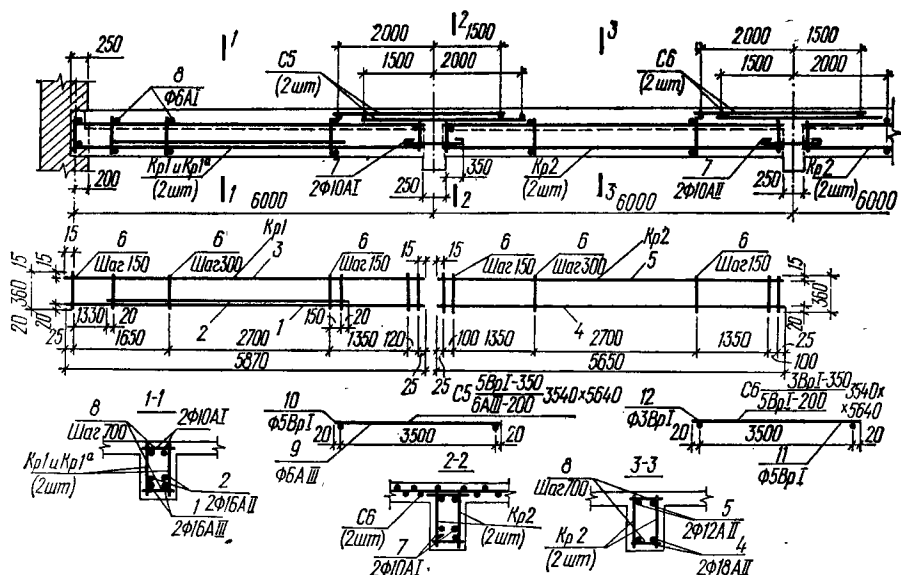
Армирование второстепенной балки сварными каркасами и сварными рулонными сетками
